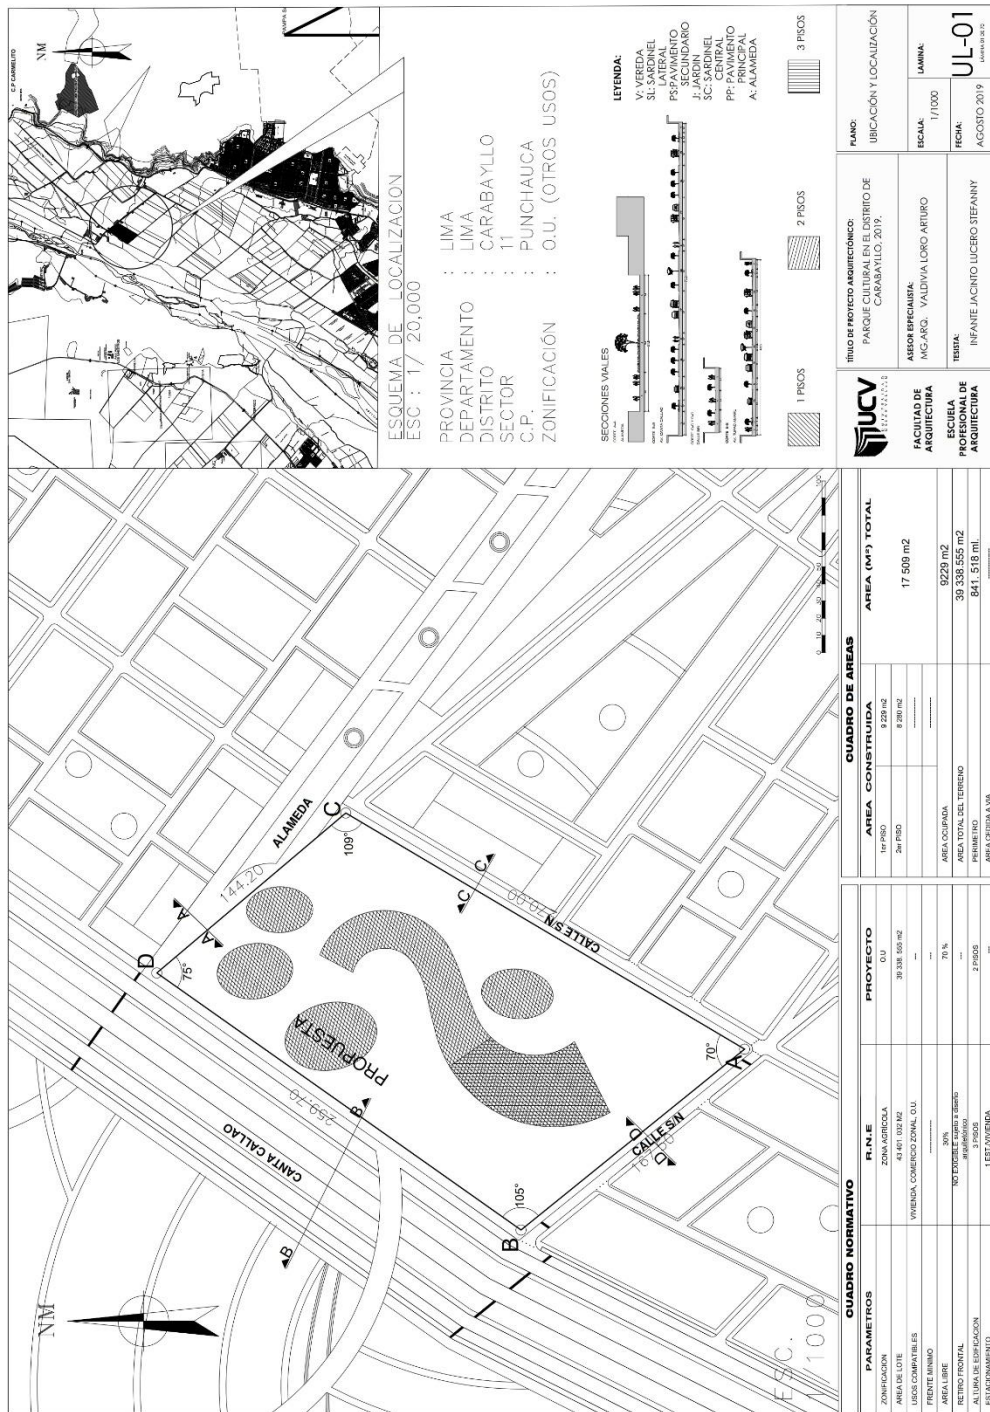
Plano de ubicación. Fuente: Elaboración propia.
